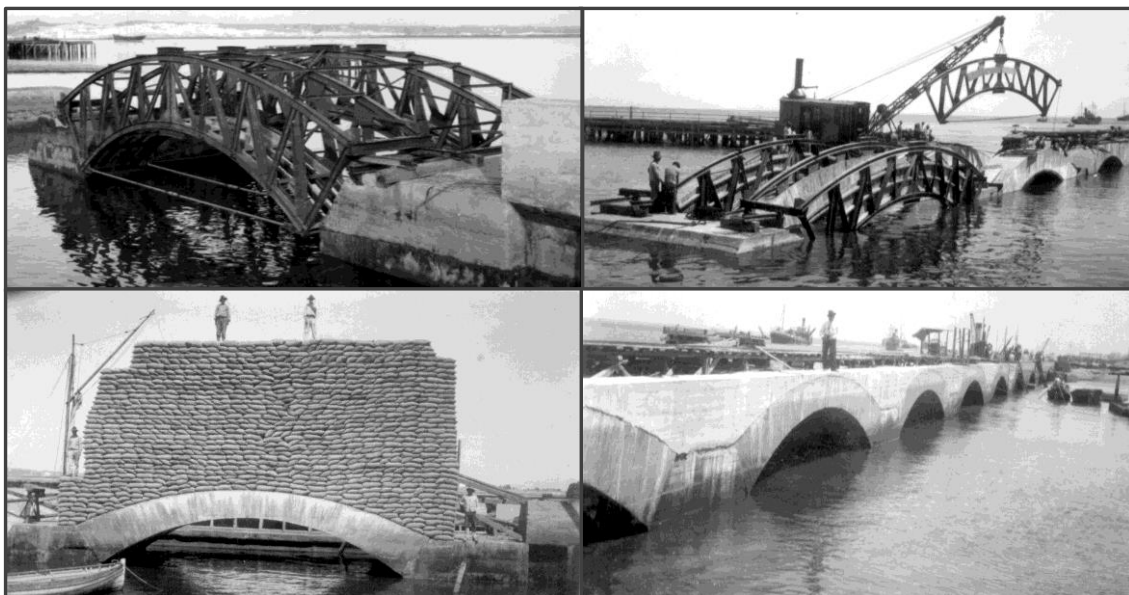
Várias fases da betonagem das abóbadas, de um ensaio de carga sobre uma delas e da betonagem de nivelamento da frente de cais
